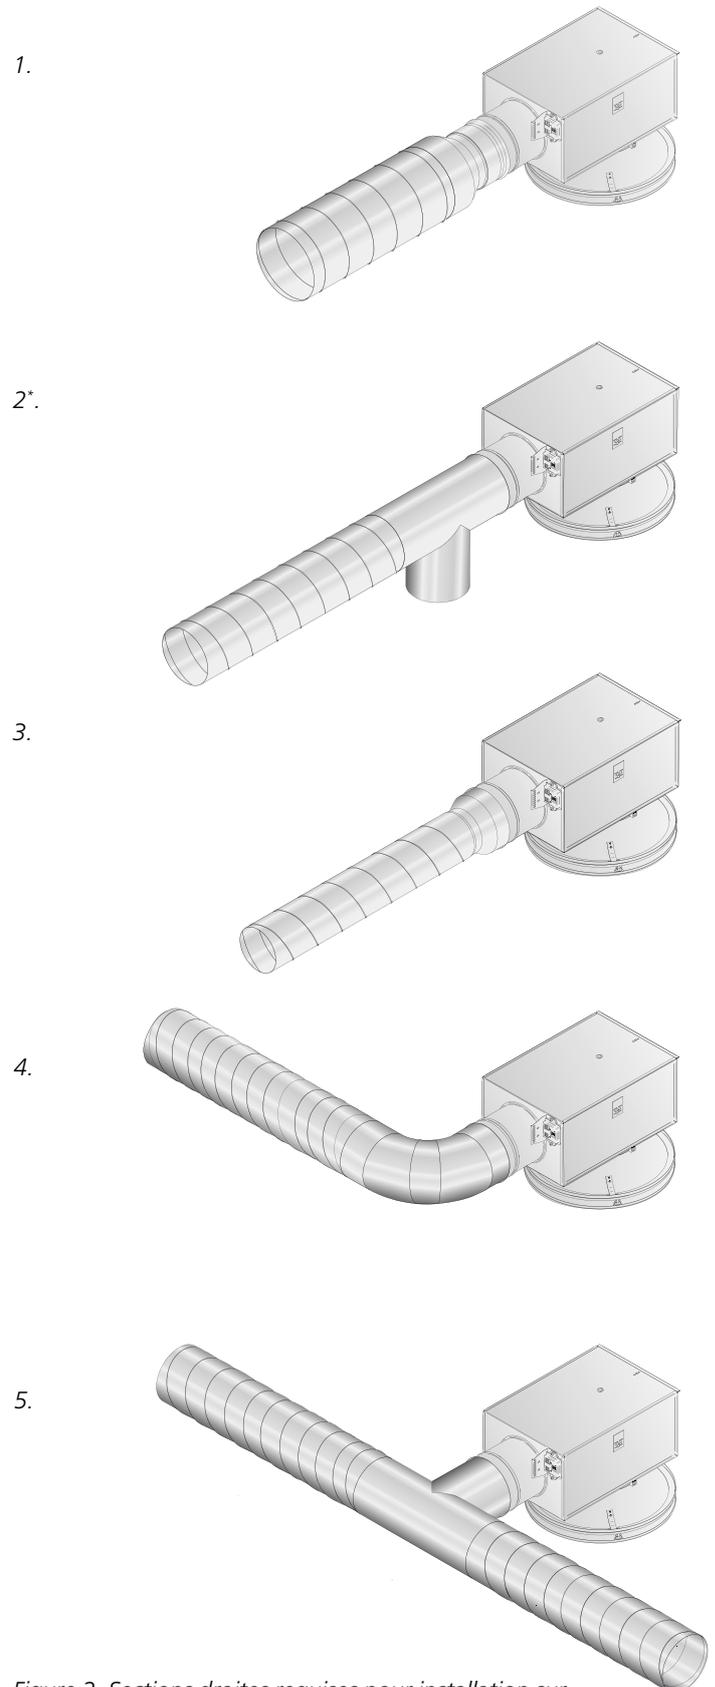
Sections droites requises pour installation sur gaine circulaire.
